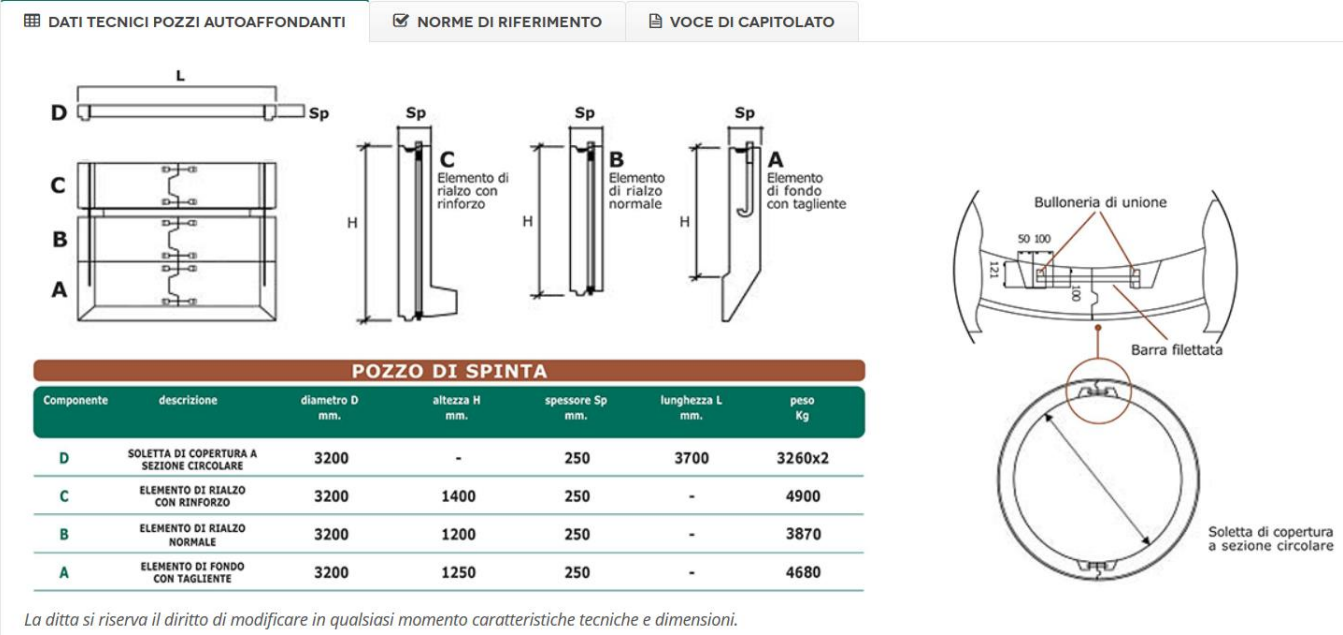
B : Specifica tecnica pozzo autoaffondante circolare
